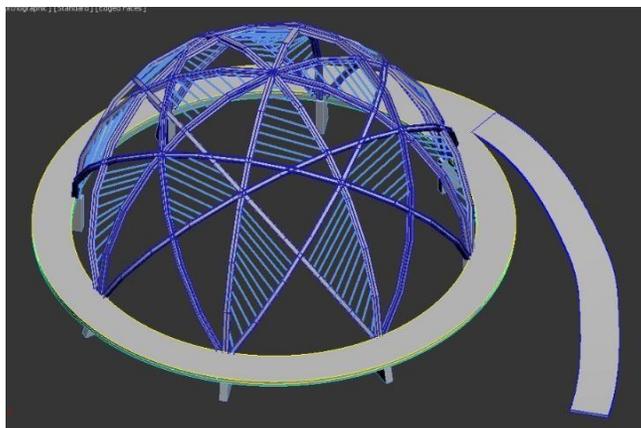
Proceso de levantamiento estructura y acceso de domo central. Fuente Elaboración propia
